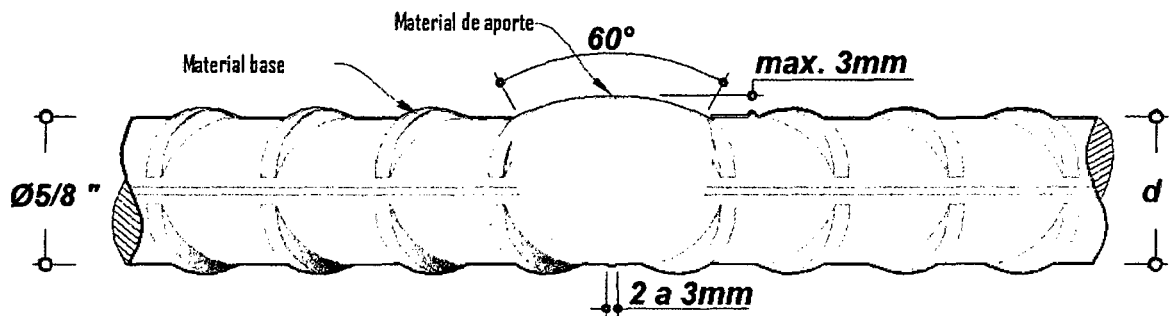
Detalle de terminado de soldadura a tope directo de barra de \varnothing 5/8".
